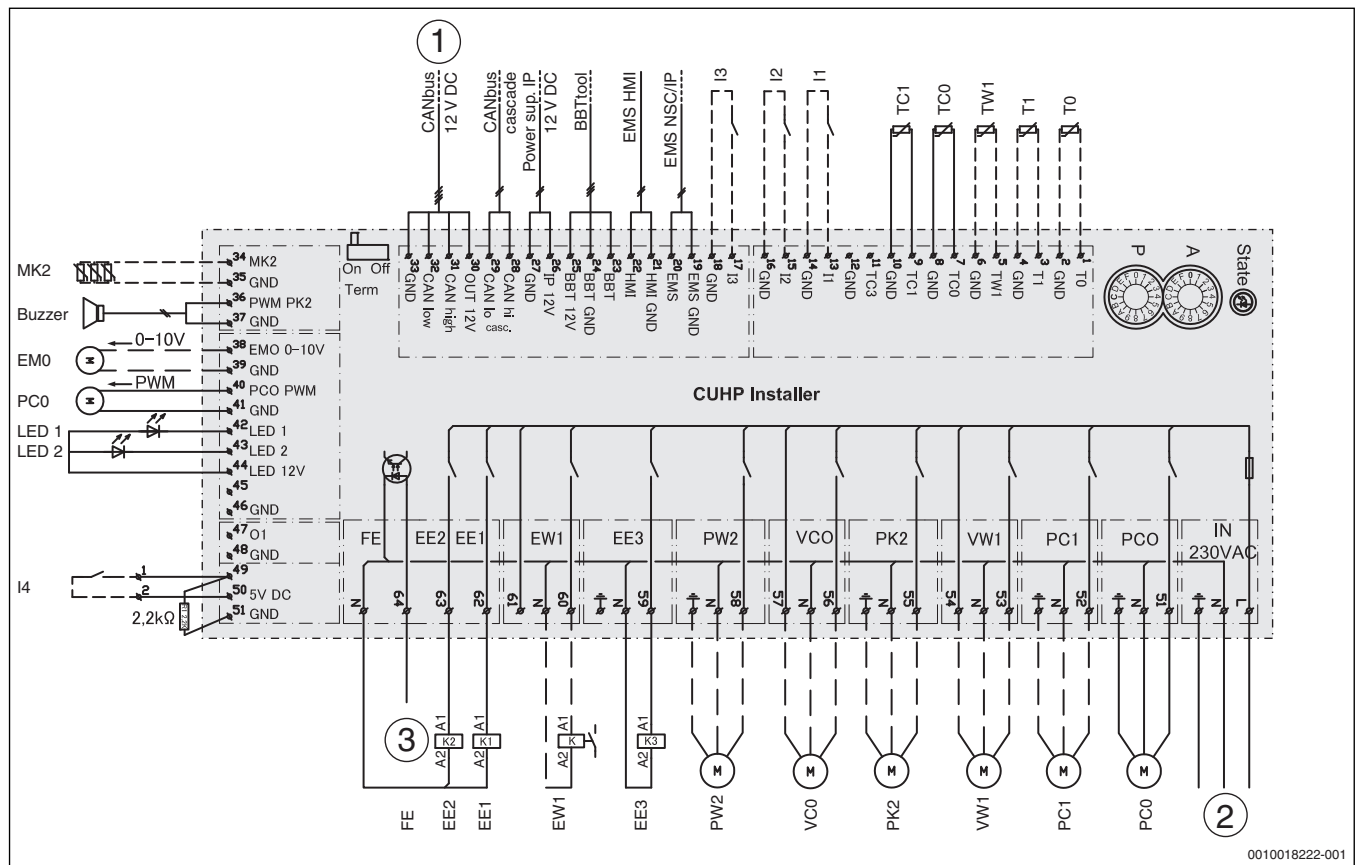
Schaltplan Installationsmodul WSW196i... ARE/IRE
